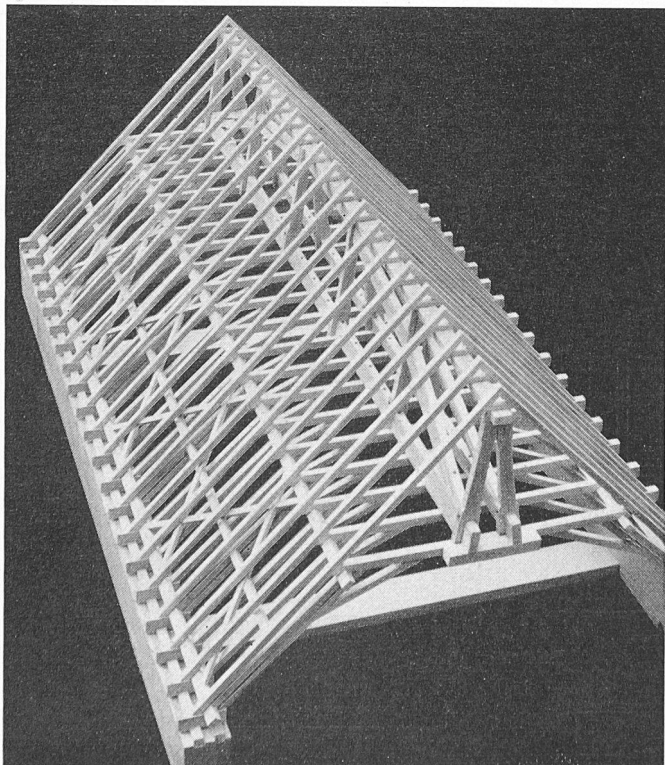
Dachstuhl mit Firstträger; Kirche in Grub AR
